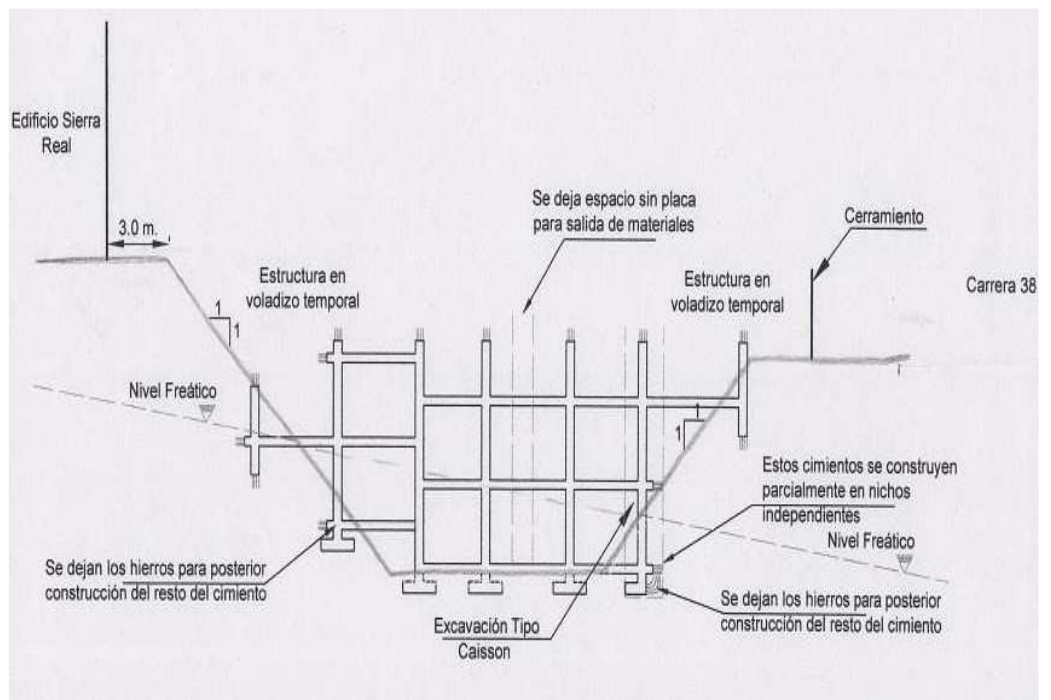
Diagrama 3 Construcción cimentación, Estudio geotécnico de suelo.
